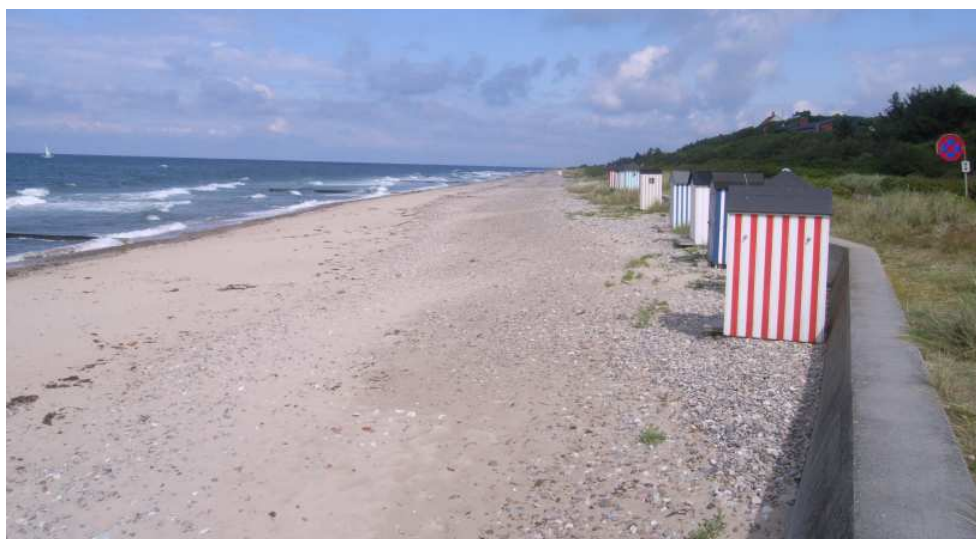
Stor betonpromenade langs kystvejen i Rågeleje
